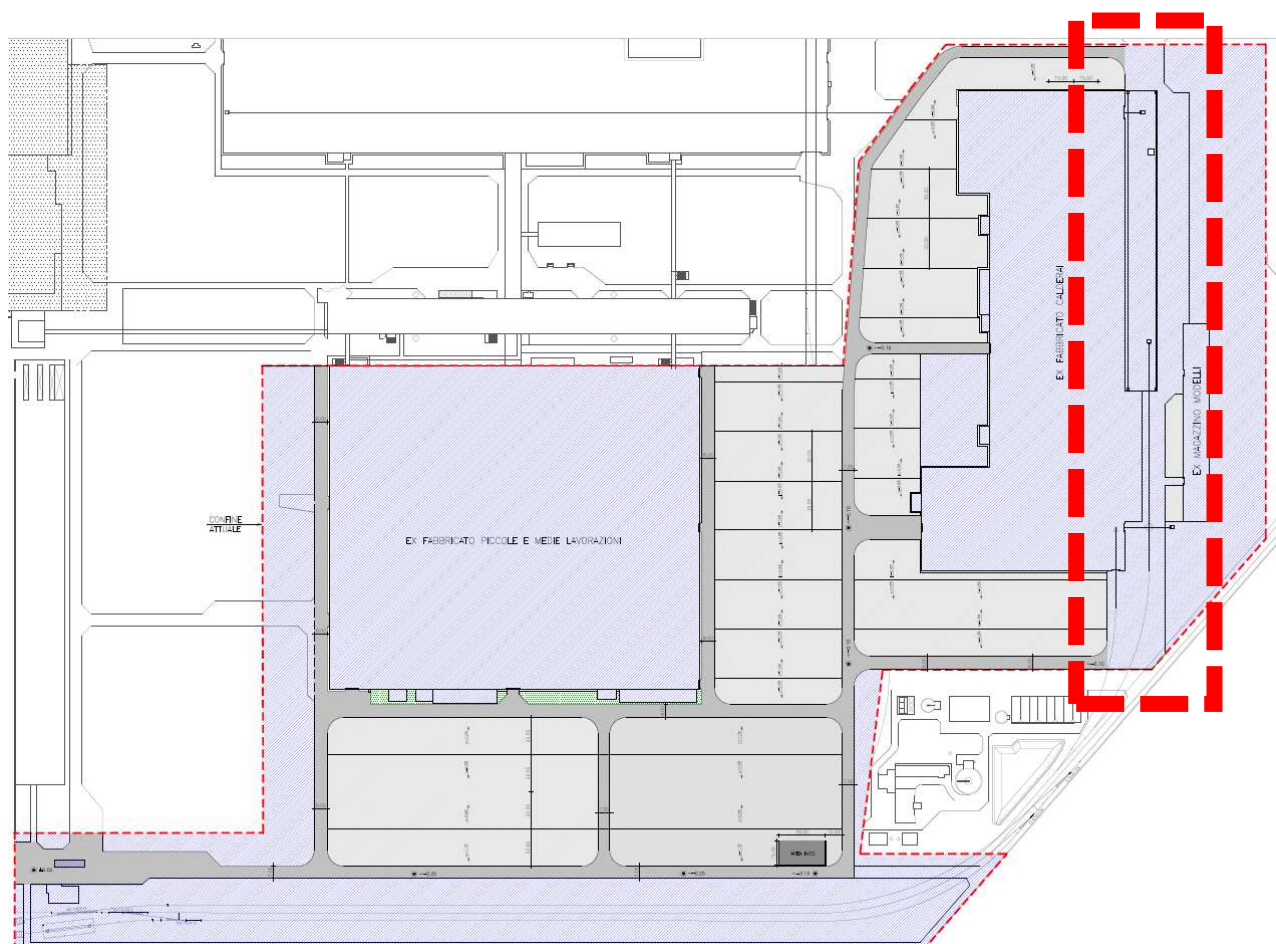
Planimetria dell’area in oggetto dell’intervento con evidenziato in rosso il piazzale
